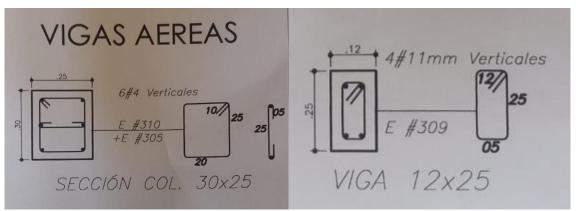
[Fotografía de Andres Vargas] Detalle de vigas de confinamiento
